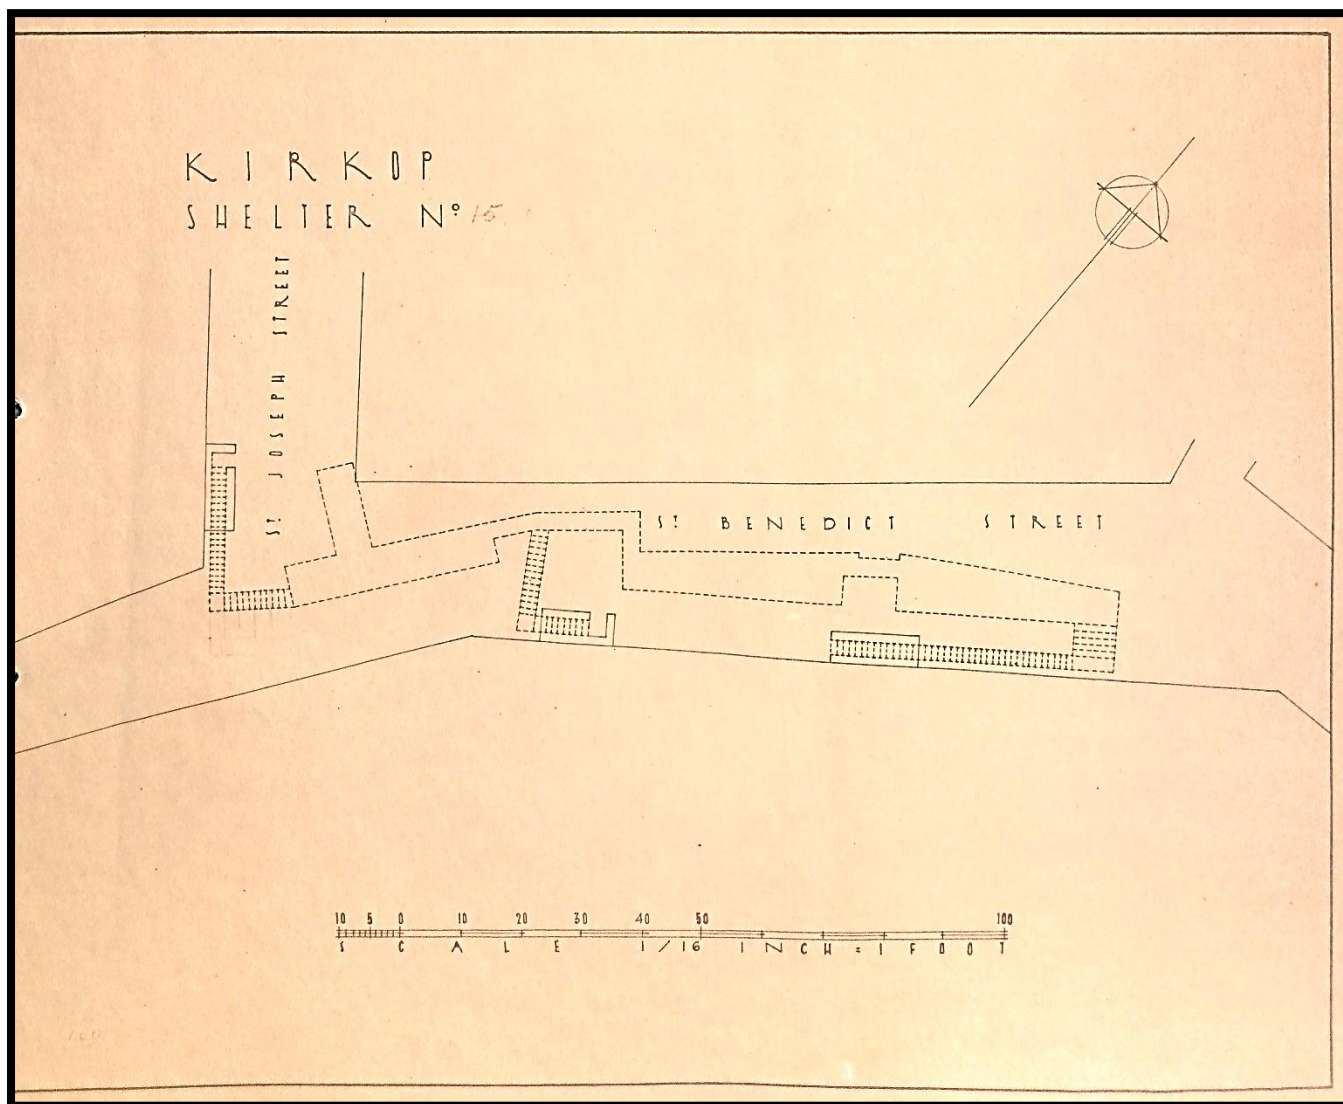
Planta do Abrigo nº15 "St Joseph Street – St. Benedict Street."
